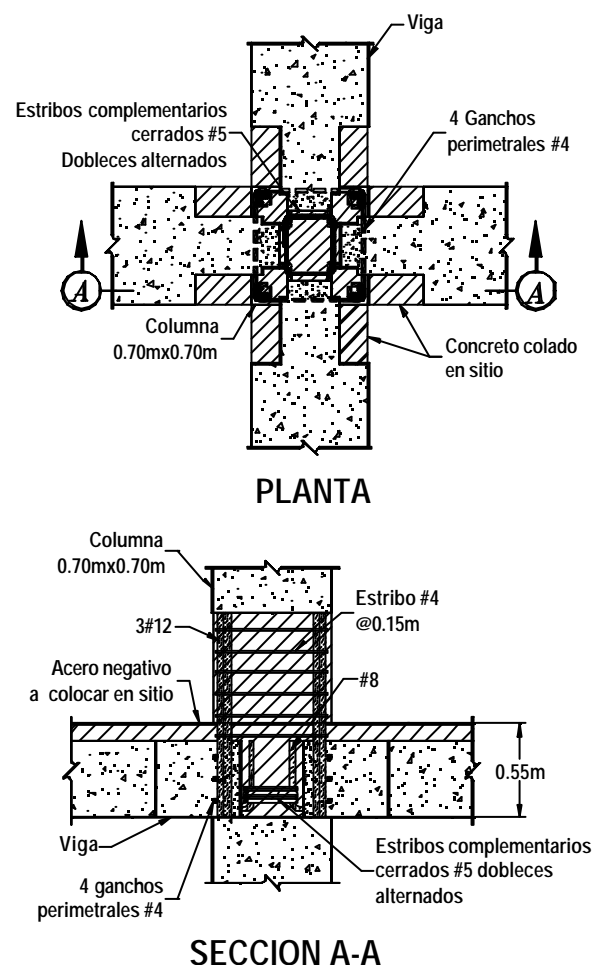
Conexión viga-columna (Carranza, 1997)
